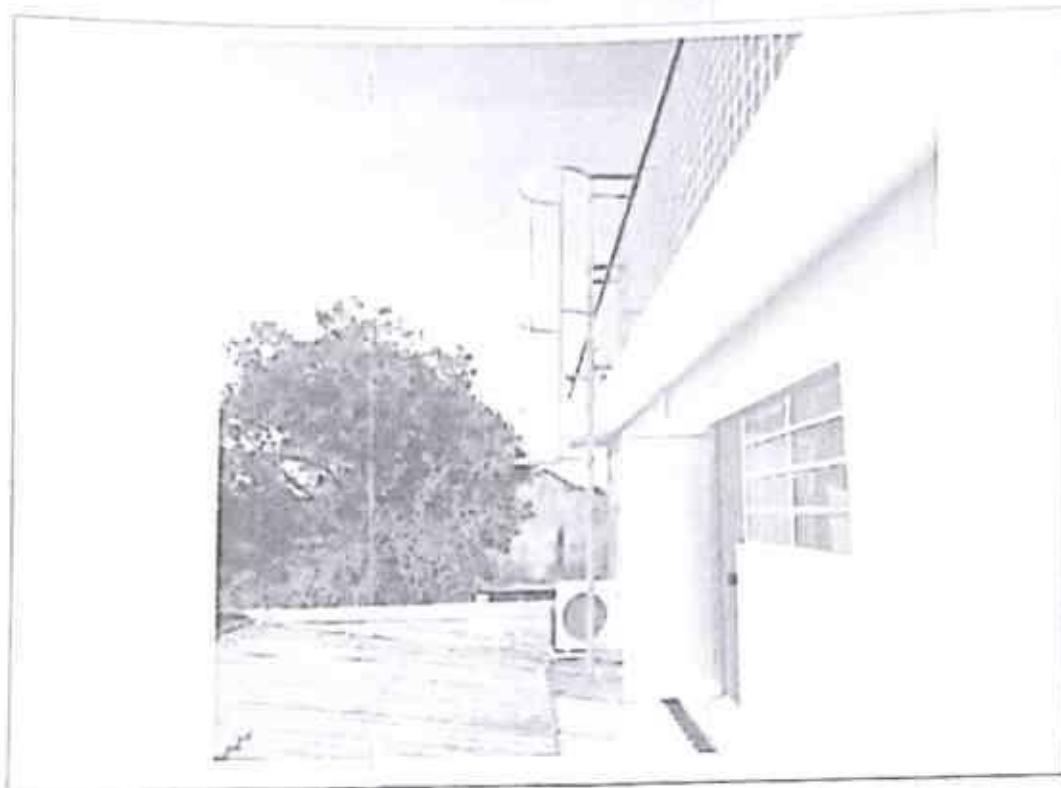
Escadas metálica de acesso ao telhado do segundo pavimento.
